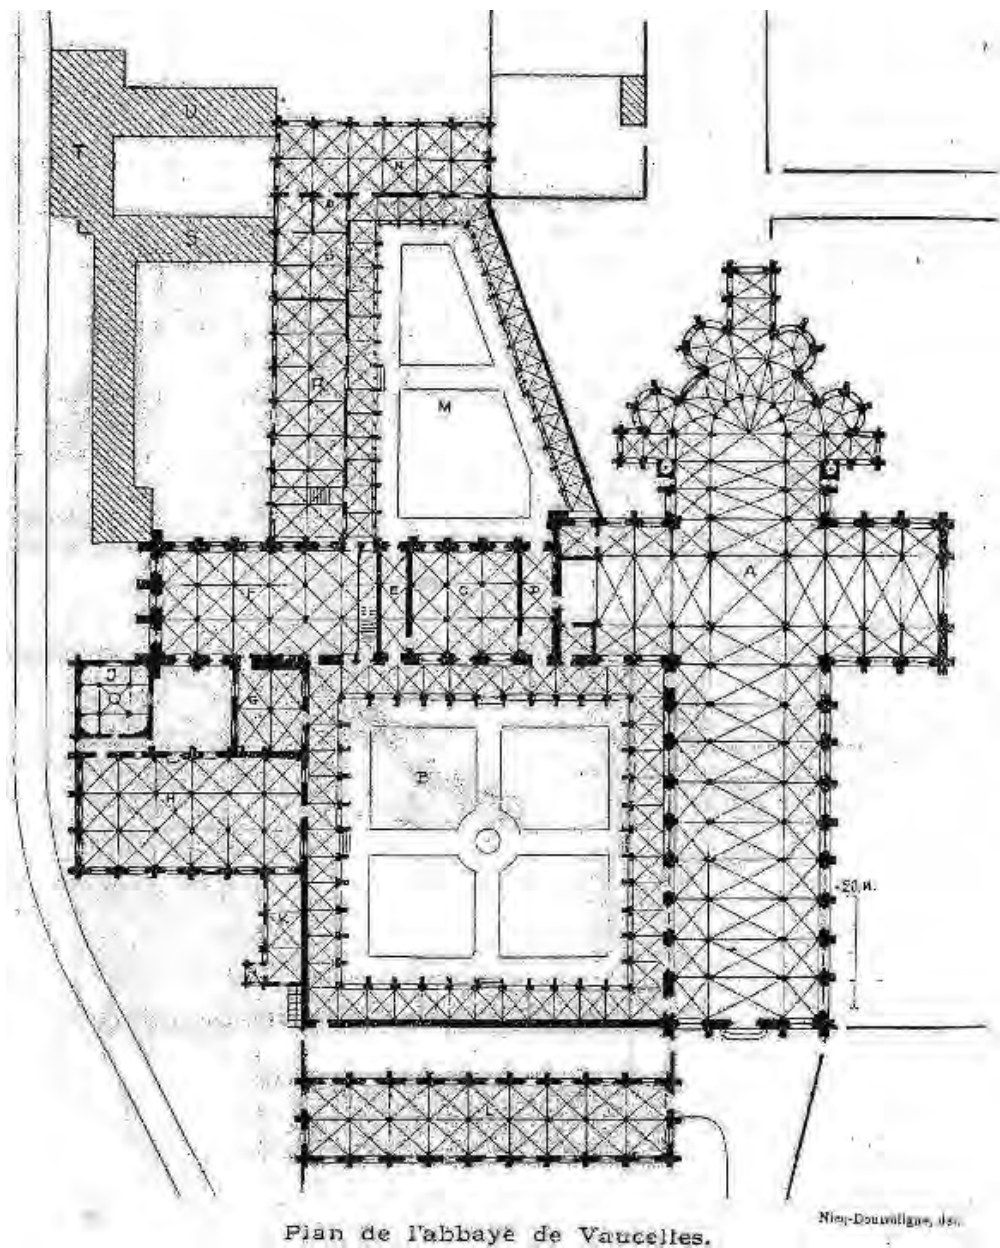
Vaucelles : plan Nicq-Doutreligne.
